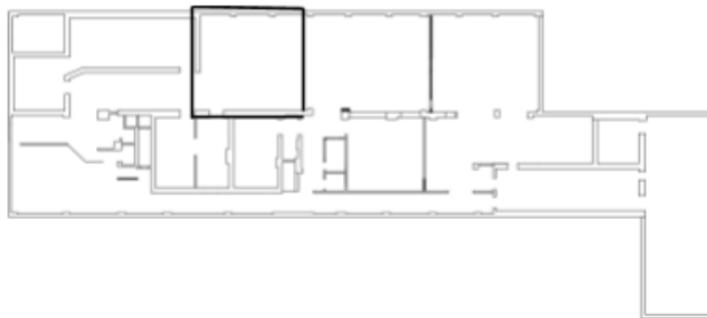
Planta baja - Recuadro de layout a detallar.
